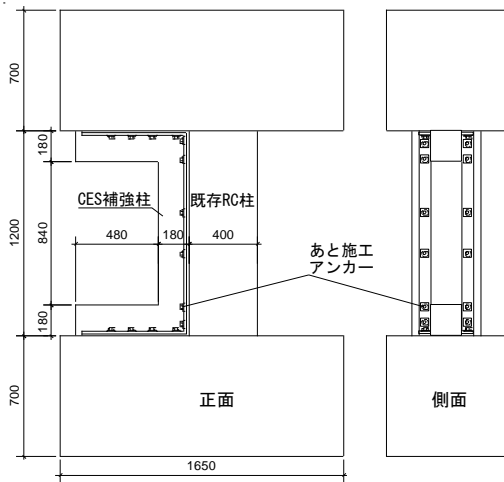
試験体概要（試験体 No. 16）及び試験体断面（単位:mm）
